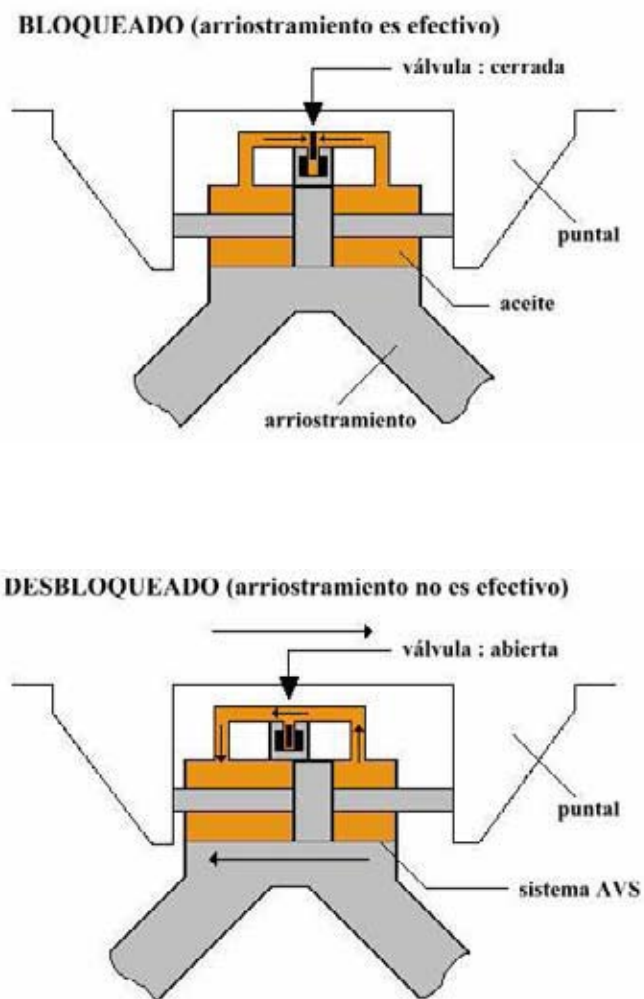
Bloqueado y desbloqueo entre viga y arriostamiento
